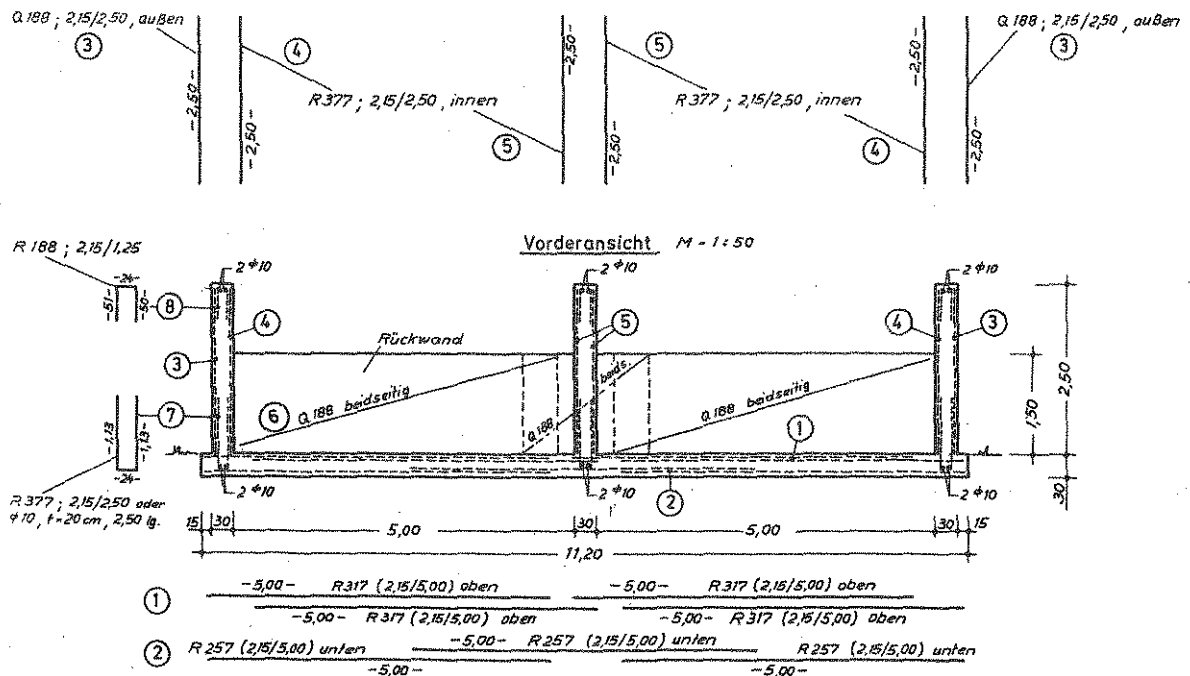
Bewehrung eines Fahrsilo ohne Dach
